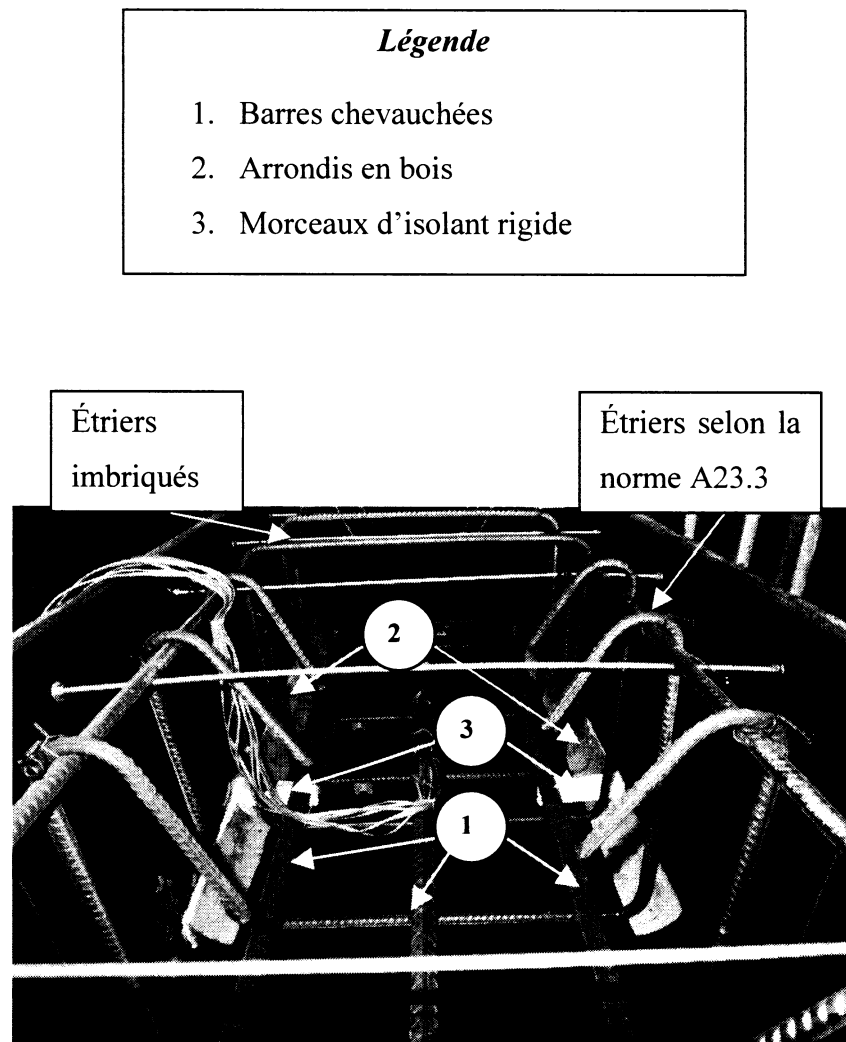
Coupe transversale des poutres dans la zone de chevauchement.
